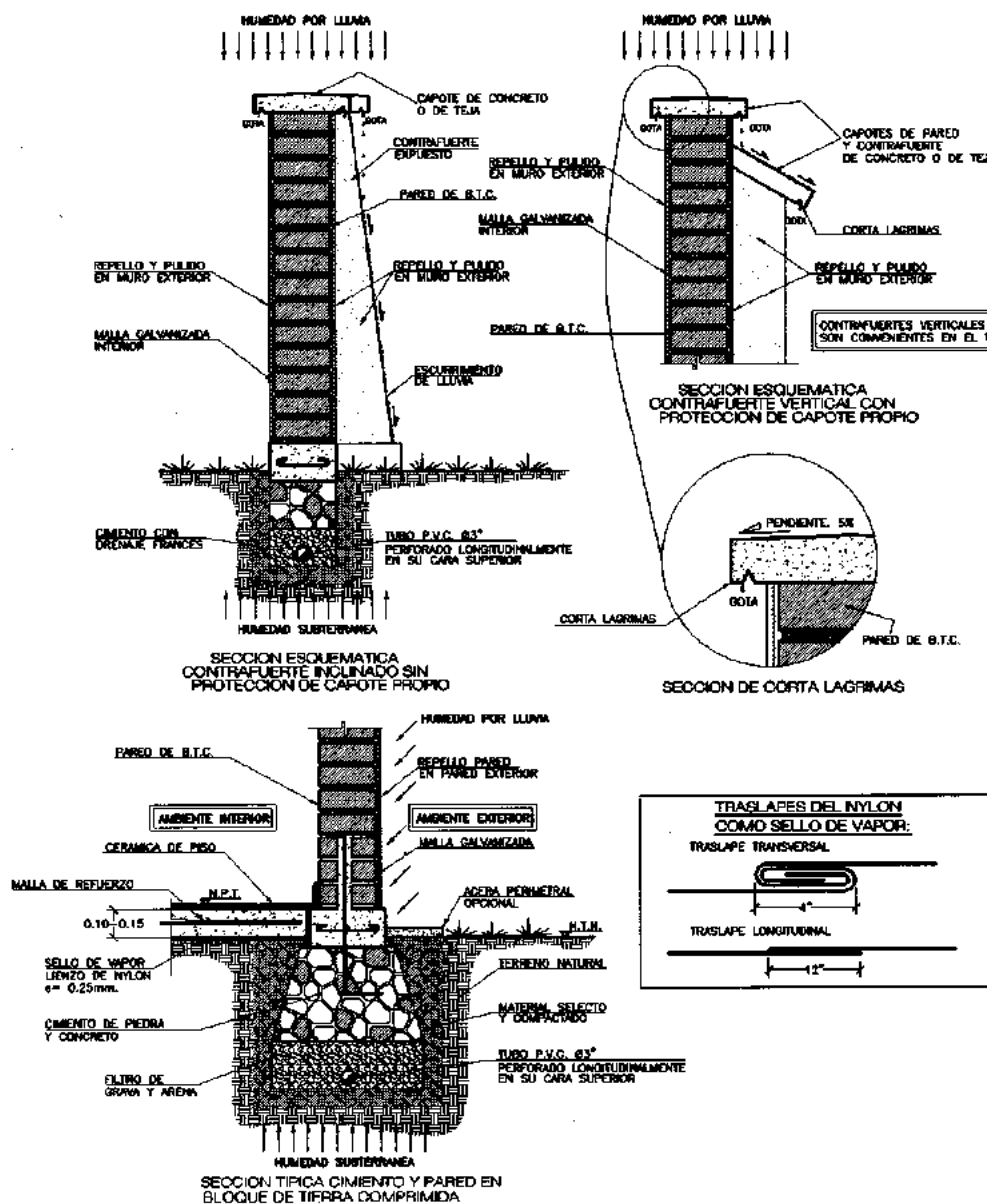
Detalles constructivos para humedad directa y por capilaridad
